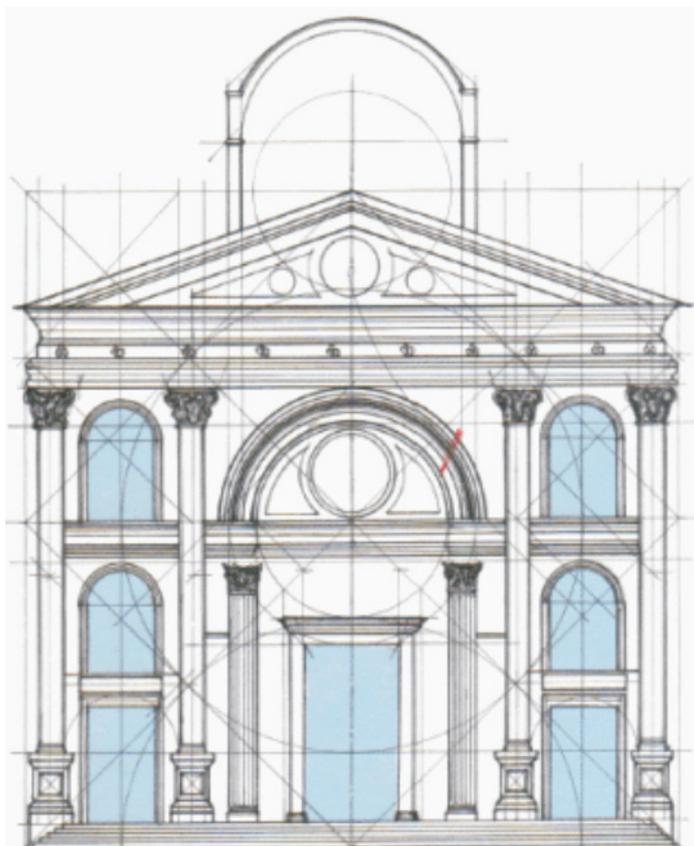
Leon Battista Alberti, Basílica de Sant'Andrea. Mantova, Itália. Desenho da fachada.
